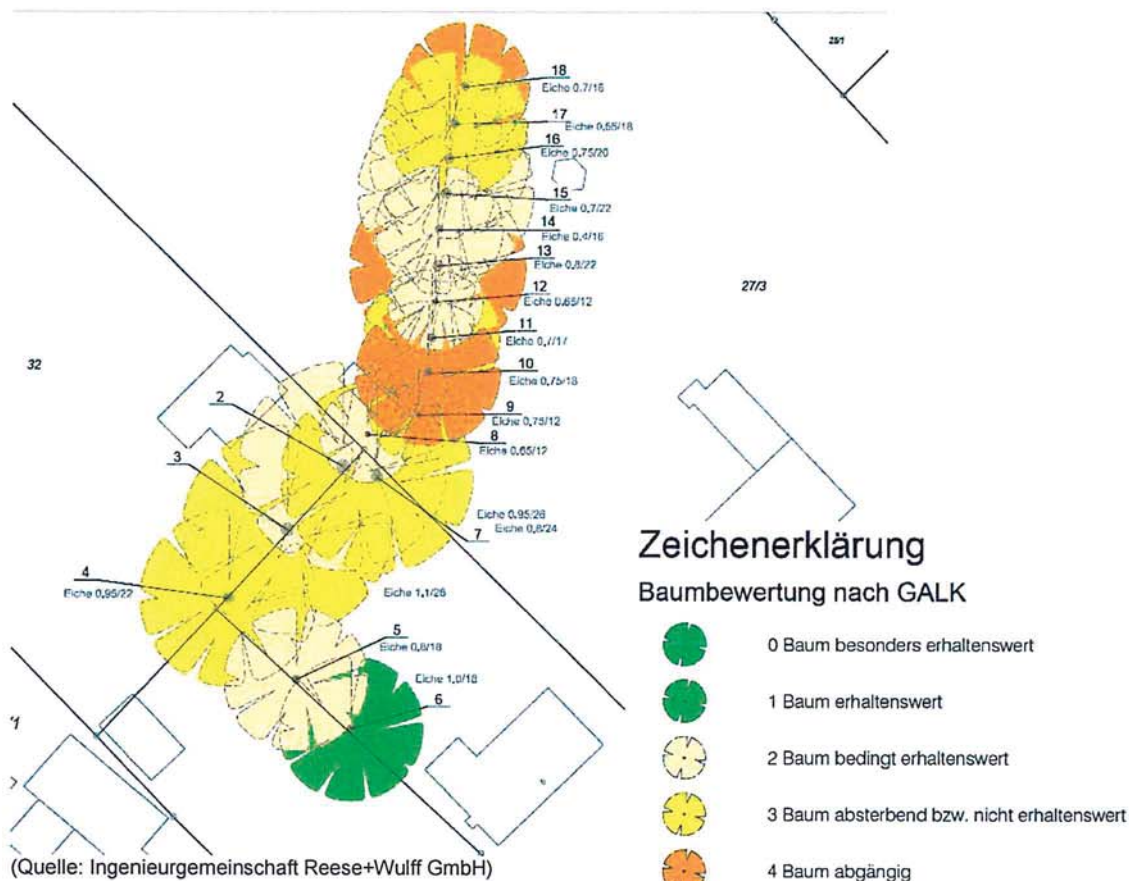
Lageplan Baumbestand (ohne Maßstab)
